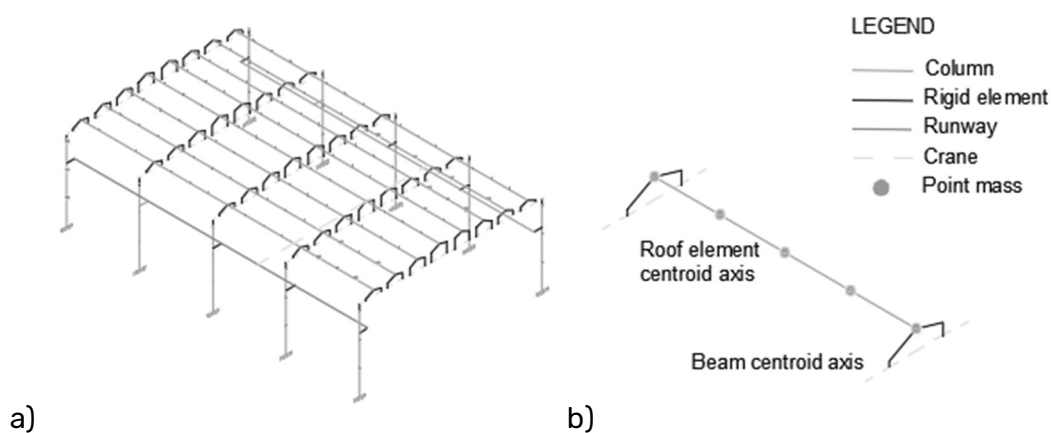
Schema illustrativo della modellazione dell'edificio (a) con particolare riferimento alla modellazione di copertura (b)
